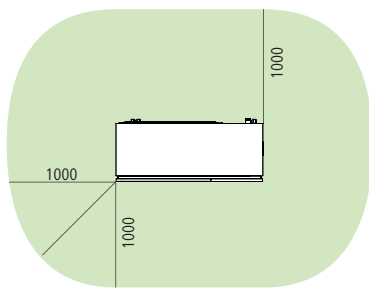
Zone de protection: installation devant un bâtiment [mm]
